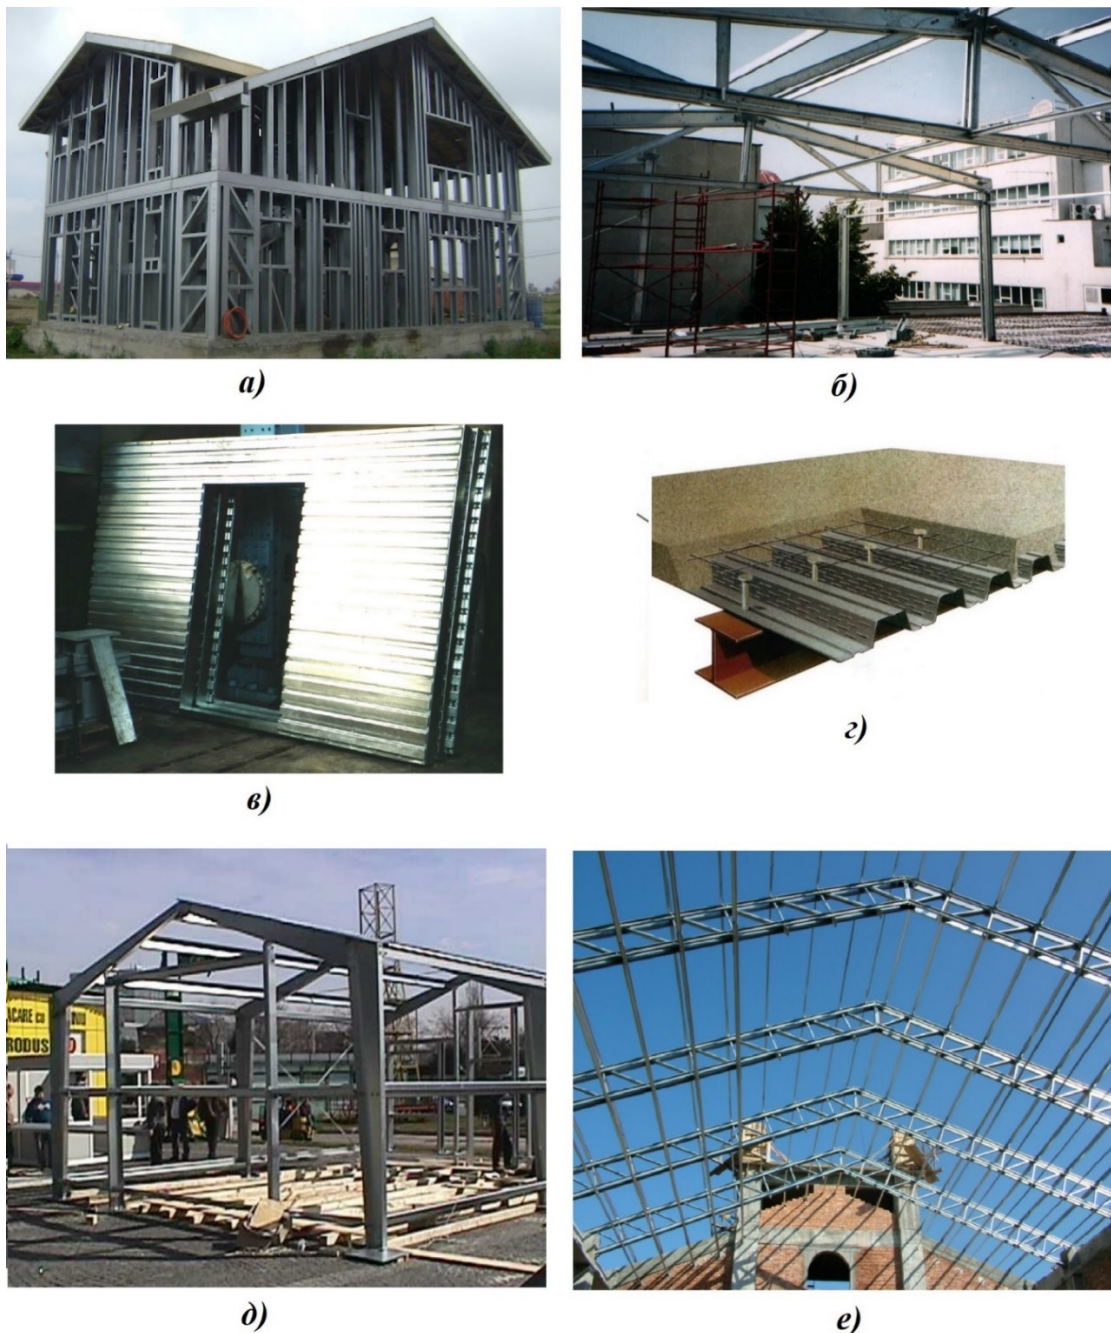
Основные конструкции из элементов ЛСТК а) каркас жилых зданий; б) мансардные надстройки; в) несущие стеновые панели; г) несъемная опалубка; д) рамный каркас; е) несущая ферма
